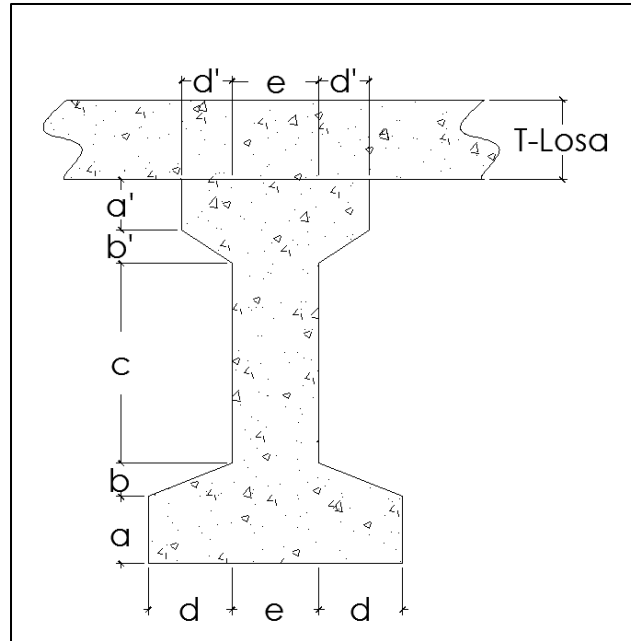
Corte transversal de la viga postensada típica (elaboración propia).
